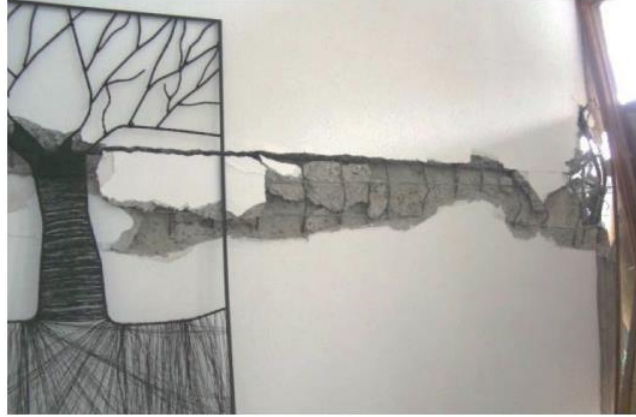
Falla por deslizamiento en la junta de construcción. Edificio Obispo Salas, Concepción en Chile. (San Bartolomé et al., 2011).
